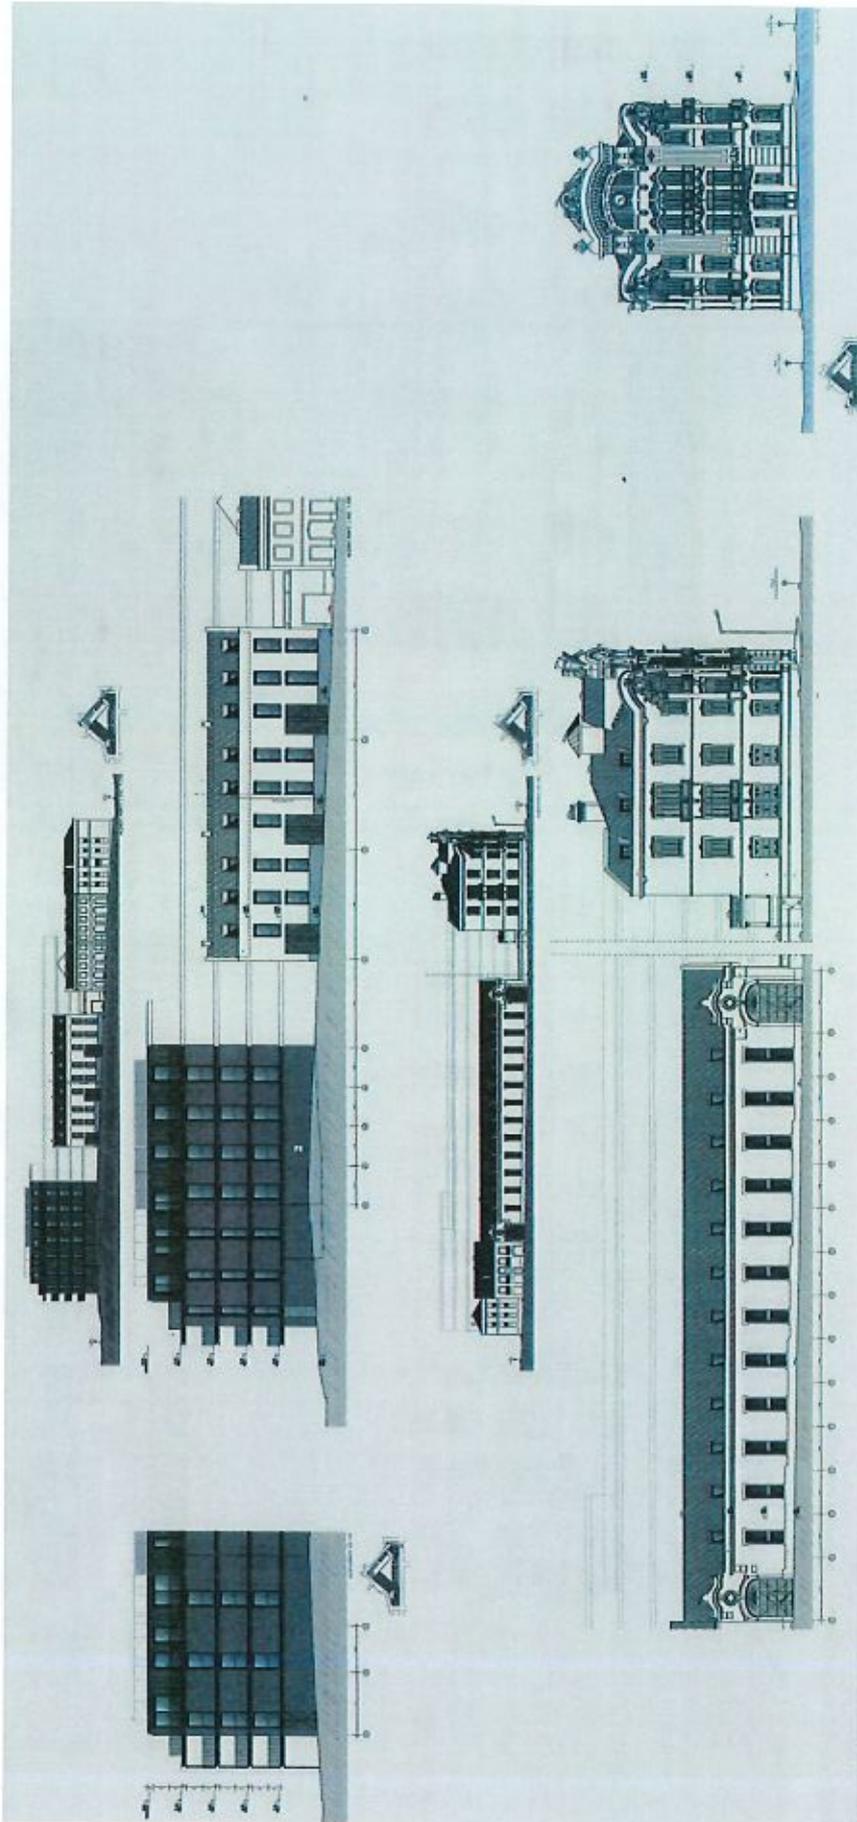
Desenho da Proposta/Projeto de Licenciamento, fevereiro de 2021. Cortes e Alçados, Alçado norte e poente / Rua Zófimo Pedroso 2.03.
